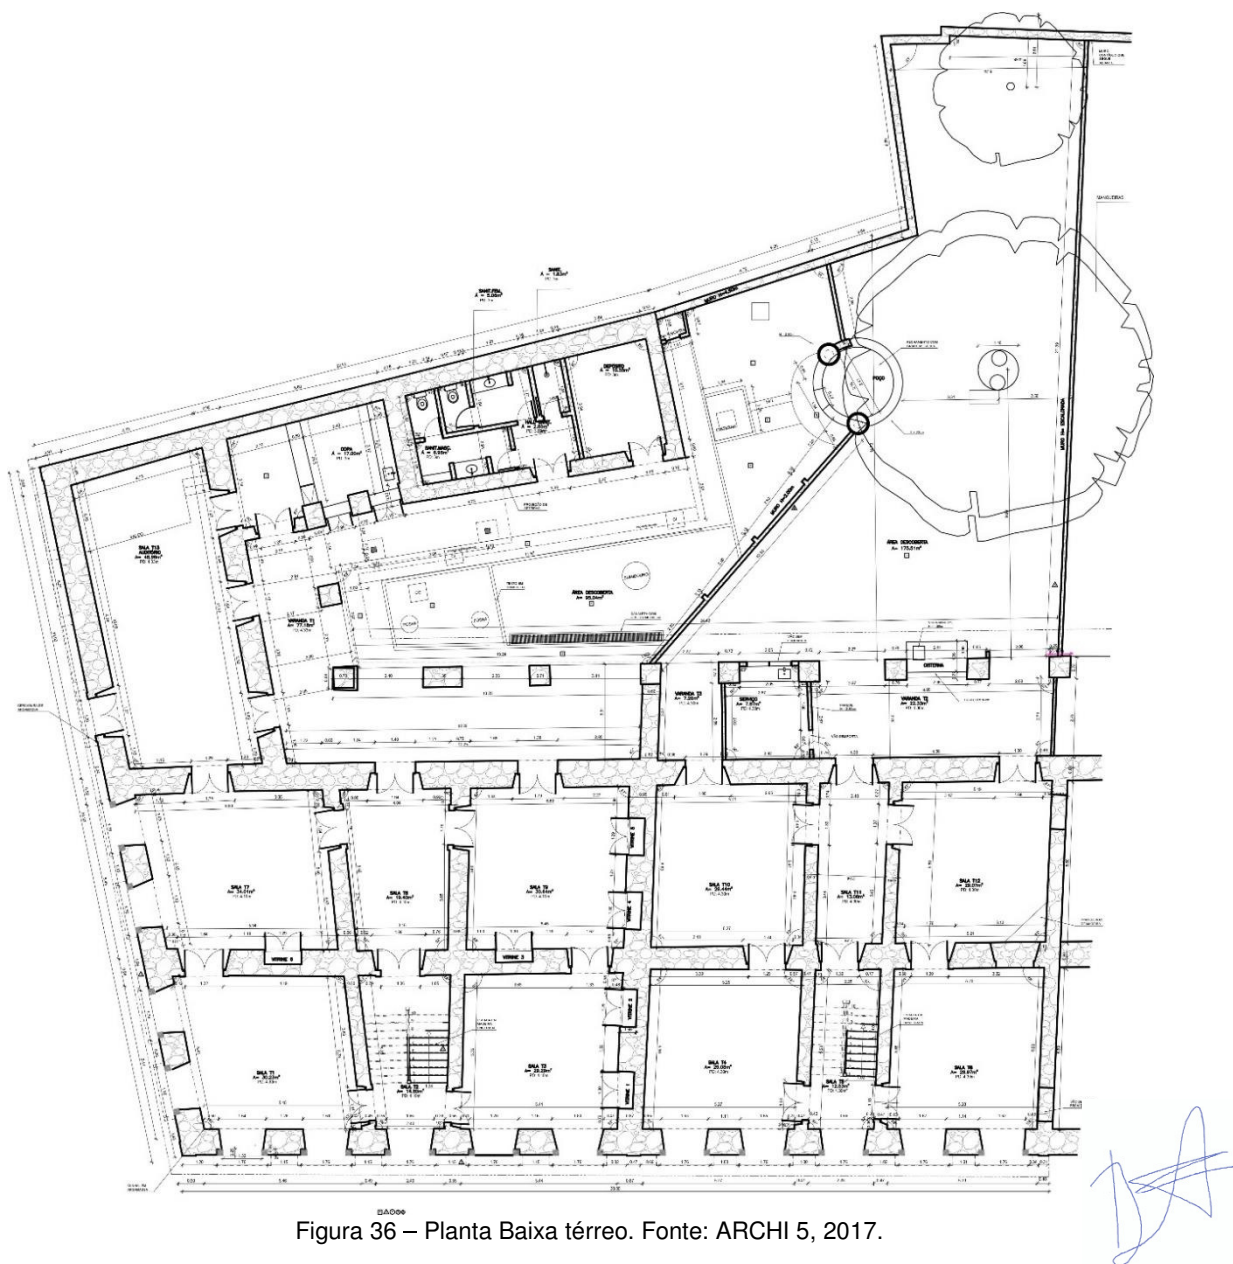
Planta Baixa térreo. Fonte: ARCHI 5, 2017.
